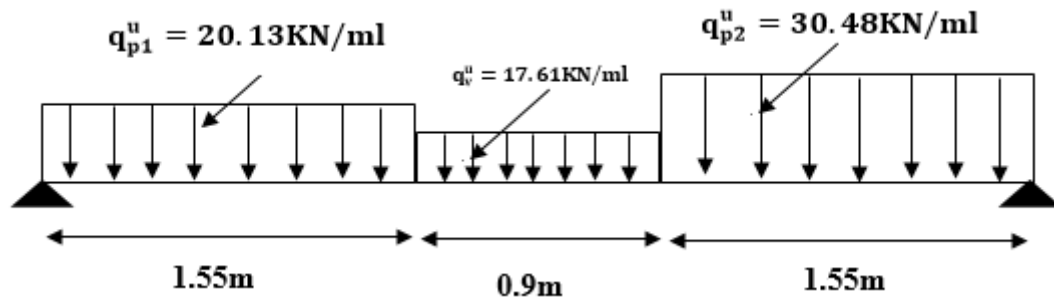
Schéma statique de la poutre brisée à l'ELU.
